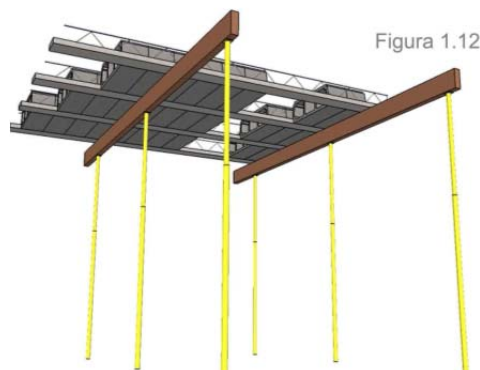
ENCOFRADO DE LOSA COPRESA
